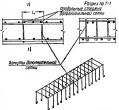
Дополиительные сварные сетки и хомуты, укладываемые в местах стыков основных сварных сеток.
